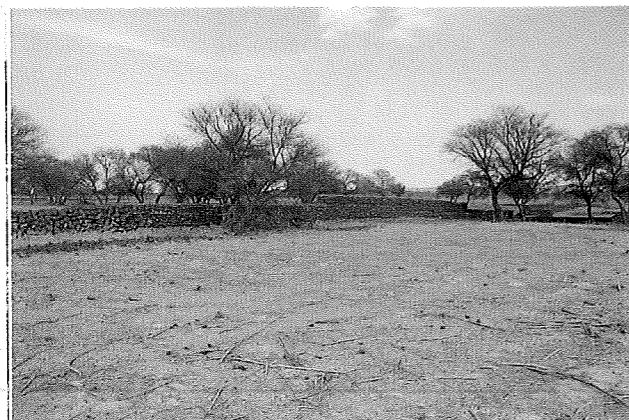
Le barrage est prolongé par des ailes en pierres qui barrent tout le bas-fond et jouent le rôle de digues filtrantes.
